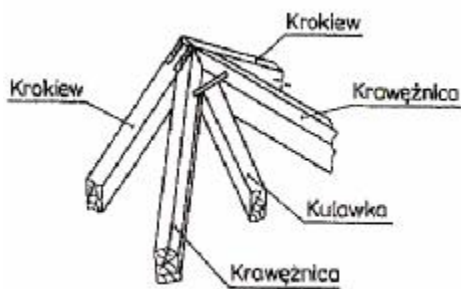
Więźba dachu czteropołaciowego o konstrukcji płatwiowej:
